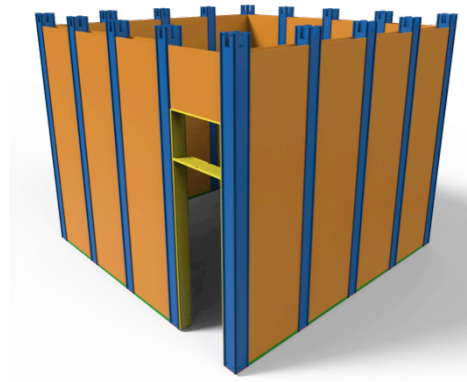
Colocación de paredes falsas, embonando con los pilares.
